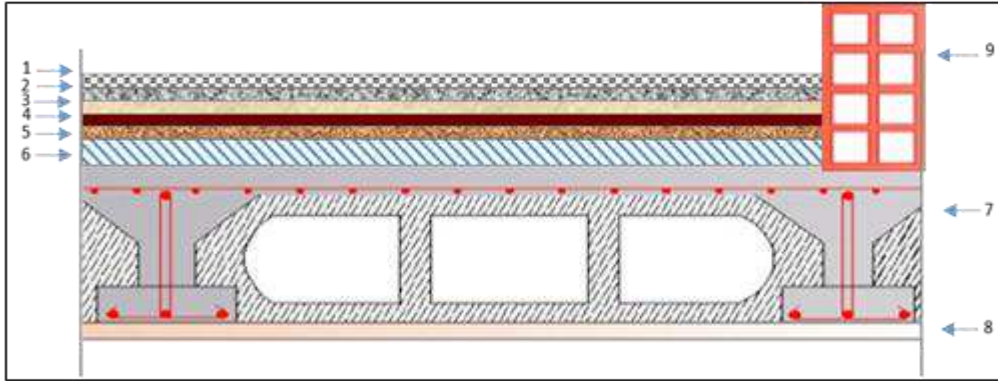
Coupe verticale du plancher terrasse accessible
